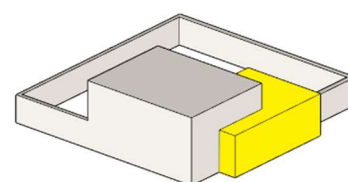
Porche y segunda planta a la casa patio. 1483
